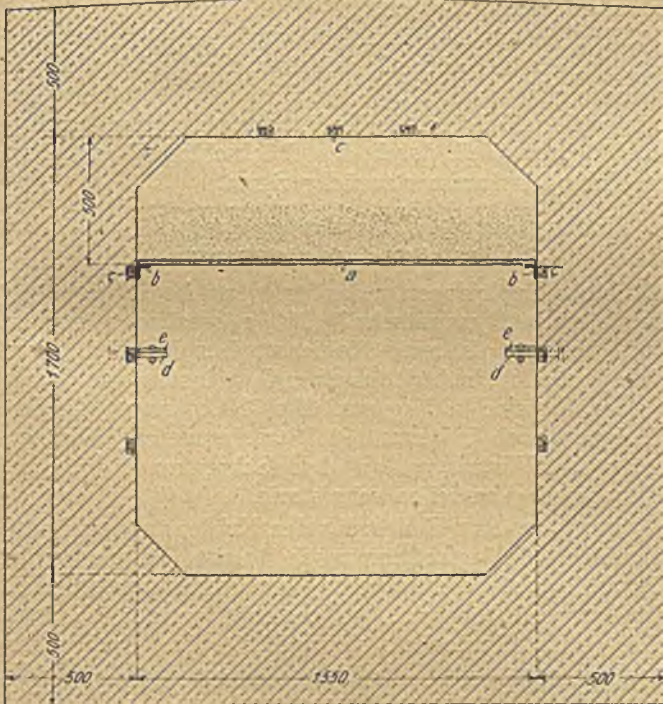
Querschnitt durch den Eisenbetonteil der Versuchsstrecke mit eingebauter Gesteinstaubschranke.
